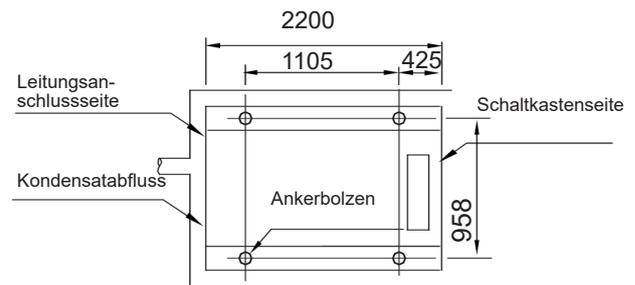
Installationsmaße (Draufsicht, Modell 60)
